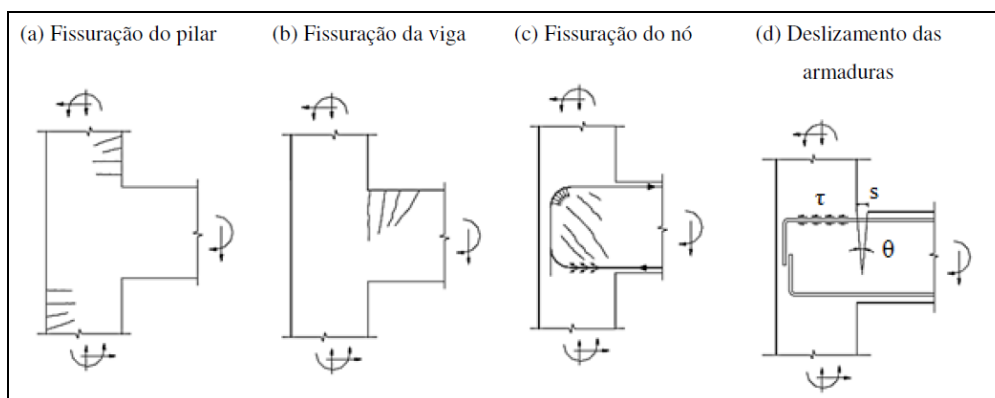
Fissuração e deslizamento das armaduras nos nós de pórtico
